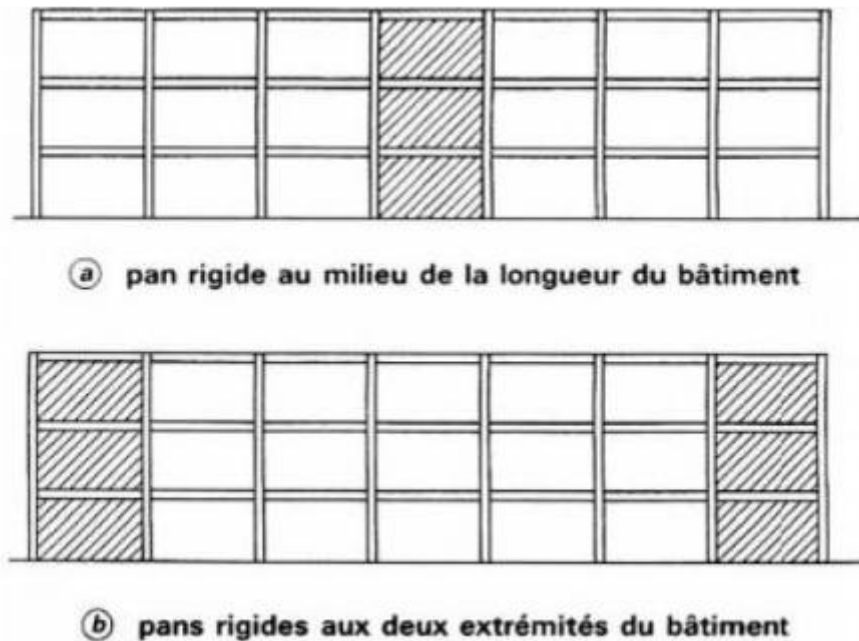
Contreventement longitudinal d'un bâtiment. Disposition des pans rigides [5]
